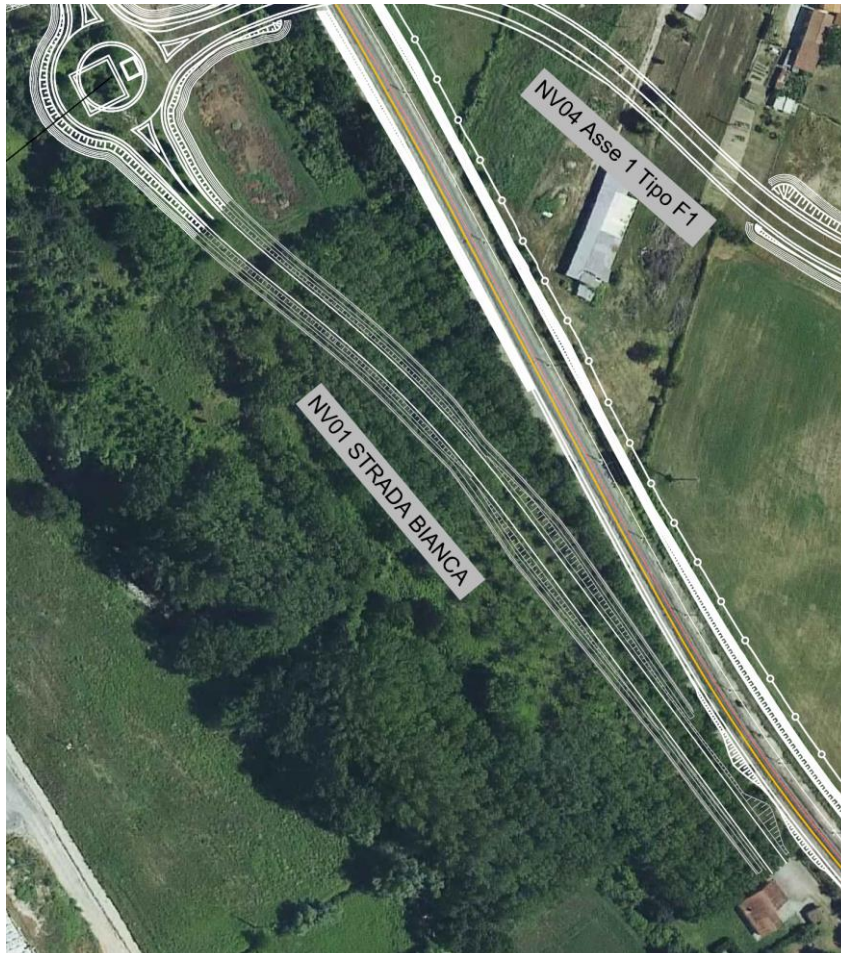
Inquadramento planimetrico su ortofoto della NV01
